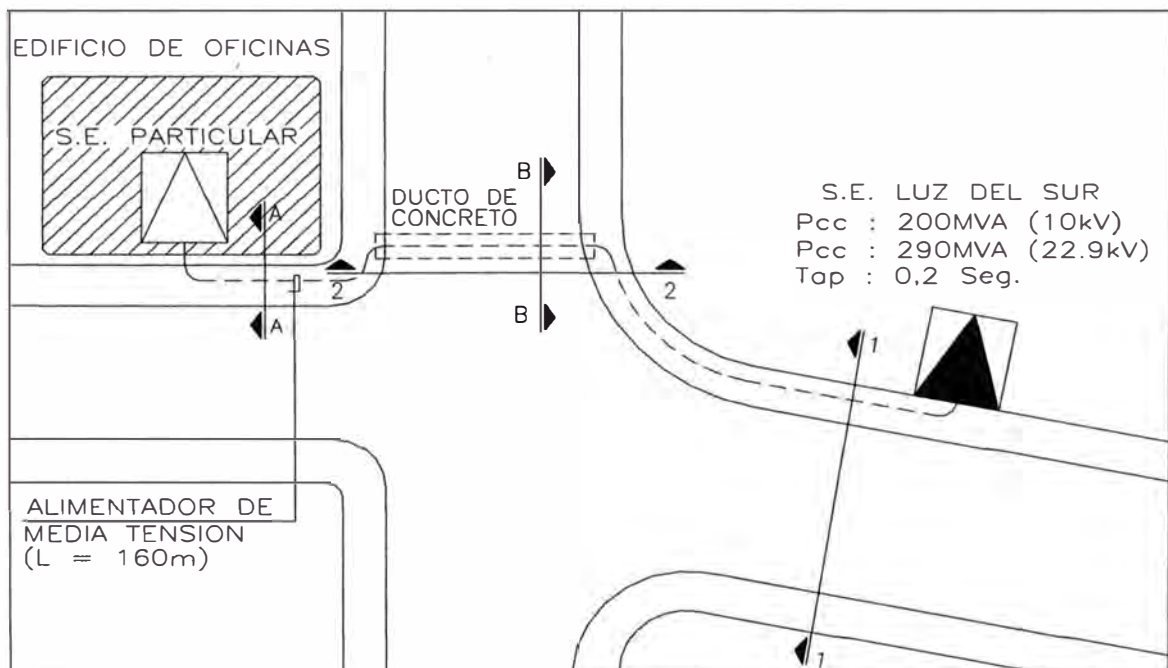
Red de media tensión instalado directamente enterrado y en ducto.
